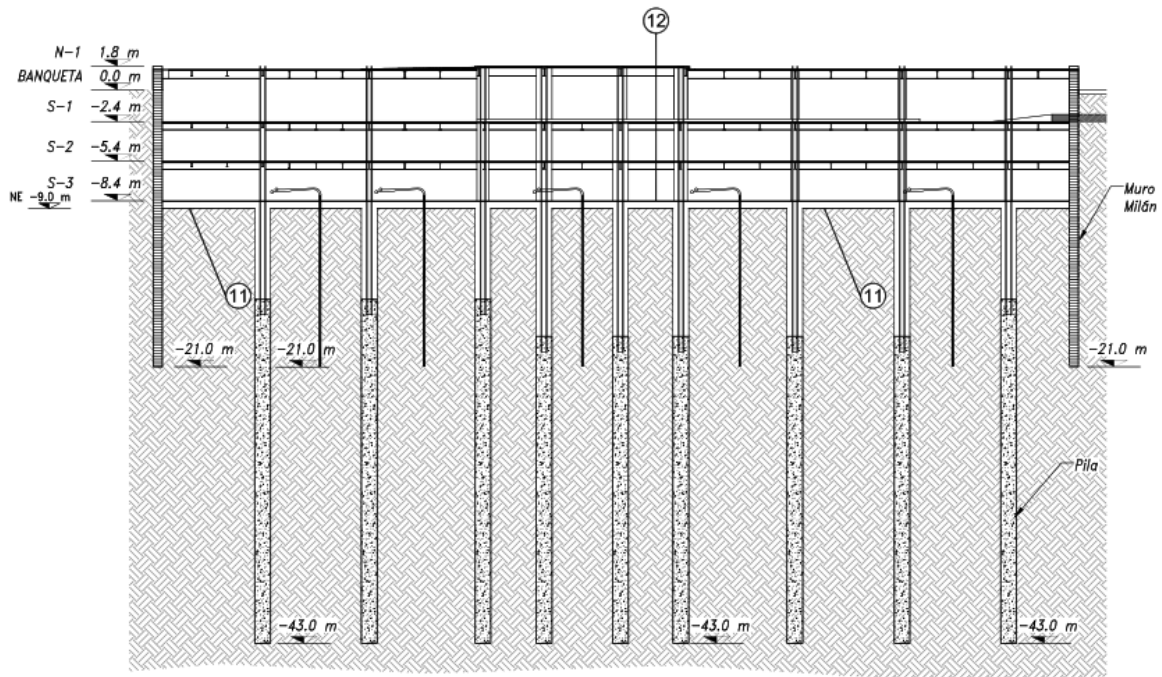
Proceso constructivo Top-Down – Etapas 11 y 12
